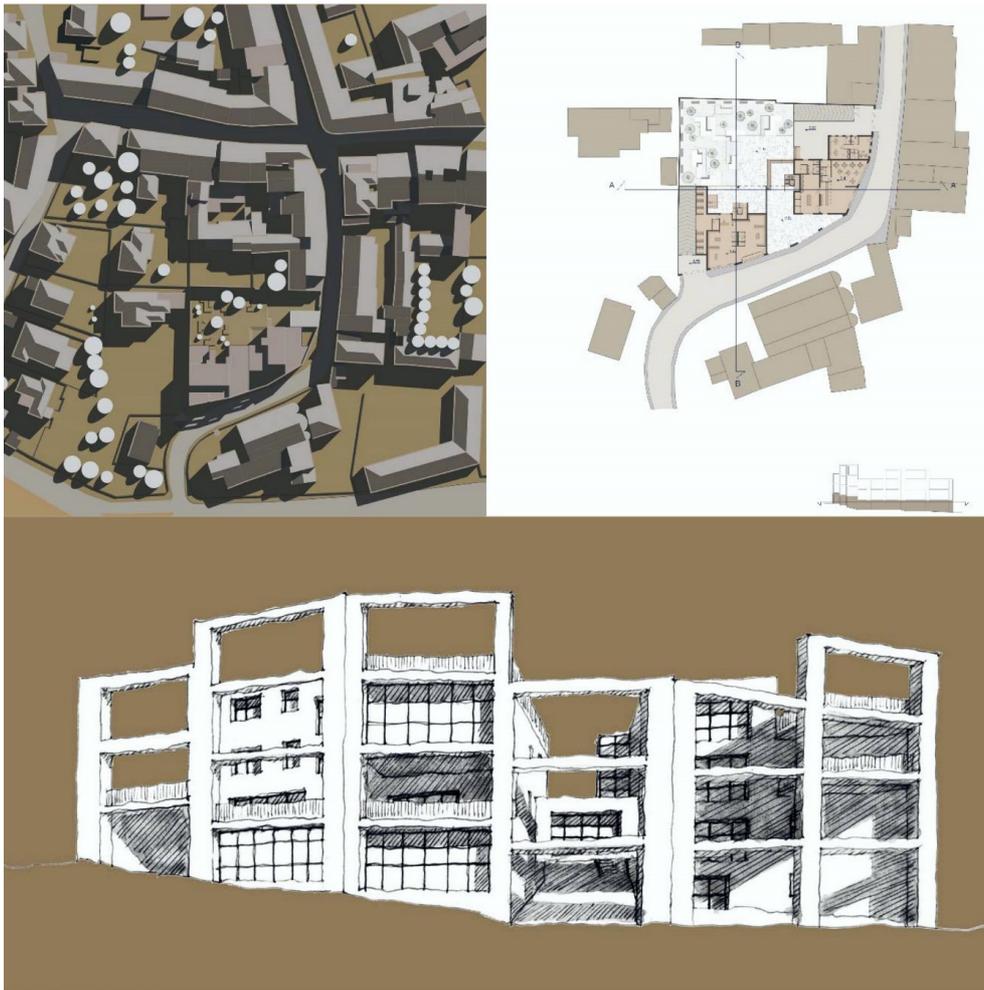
, 15, 16 | Progetto di riqualificazione dell'area di San Silvestro a Vicenza. Planivolumetrico di progetto, planimetrica di progetto, studio della facciata con il sistema del portale reiterato. Dal lavoro di Silvia Ganassin, Stefania Masin, corso di Composizione Architettonica Urbana 2.
